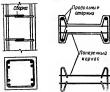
99. Пространственный каркас колонны, образованный из двух плоских каркасов с поперечиыми стержнями, согнутымн в виде буквы П.
